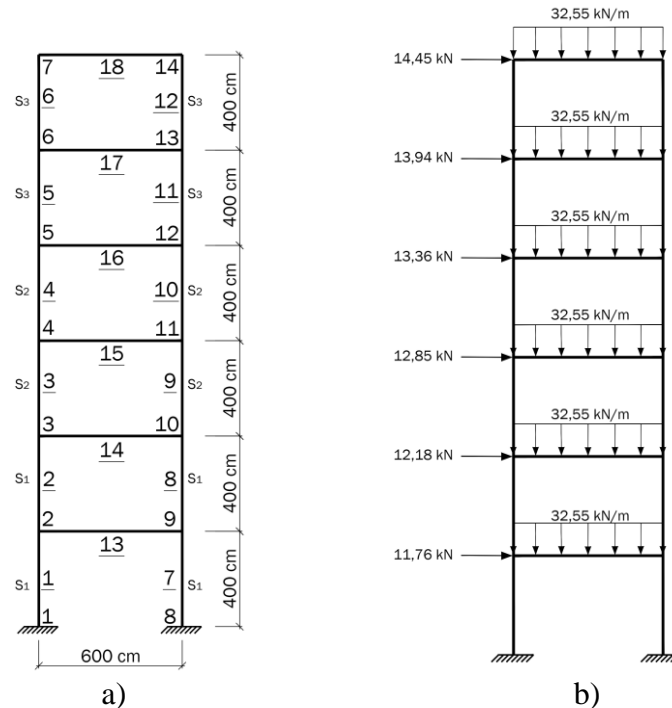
a) Dimensões e numeração; b) Ações de cálculo na estrutura (adaptado de SOUZA et al., 2018).
